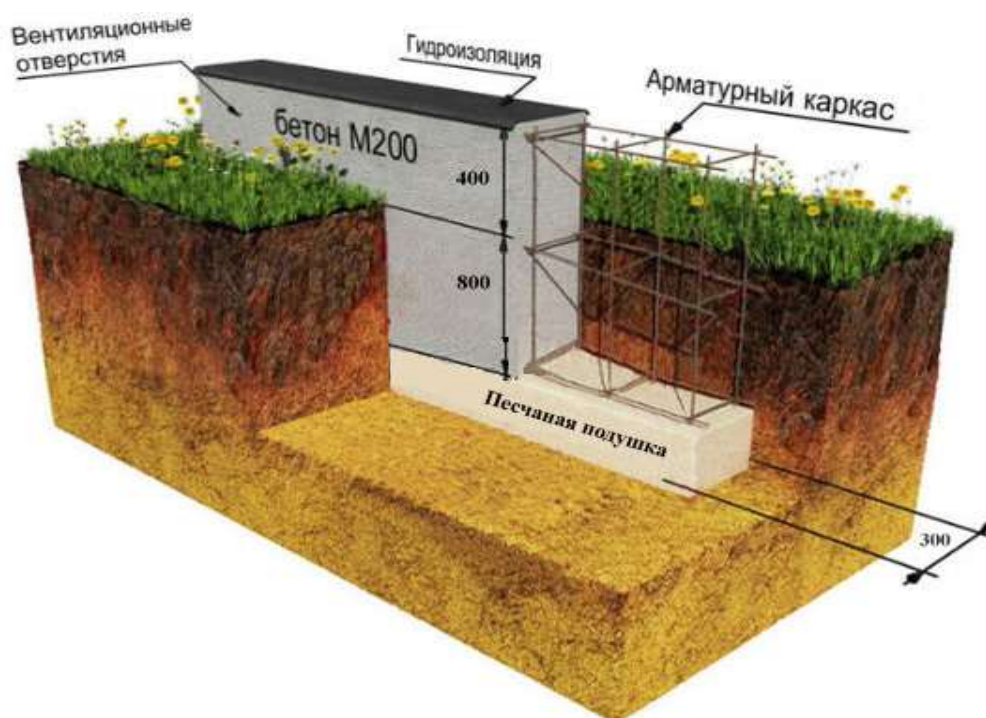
Пошаговая инструкция строительства ленточного фундамента:
